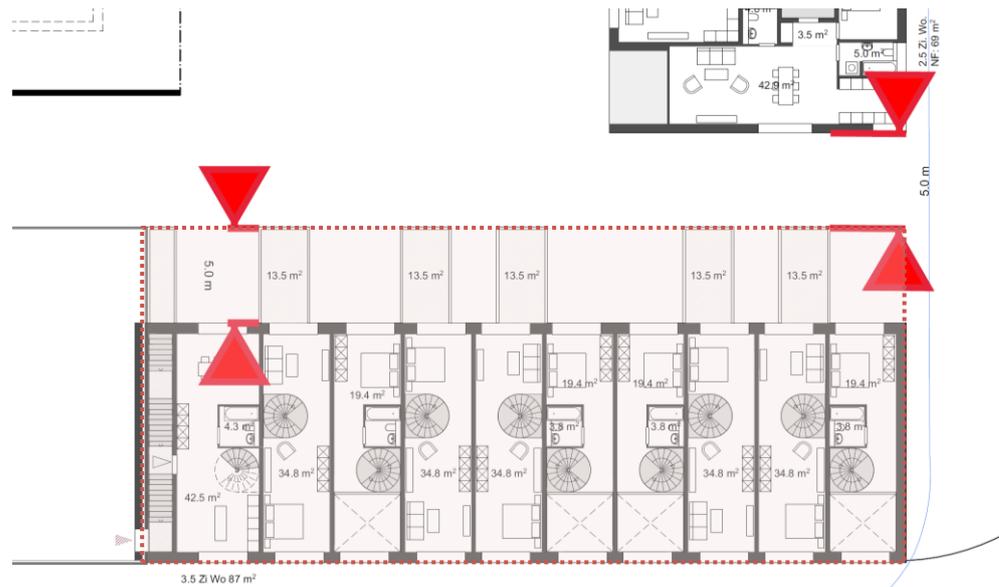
Auskragende Balkone im Baubereich A1 (rot) gemäss Richtprojekt
